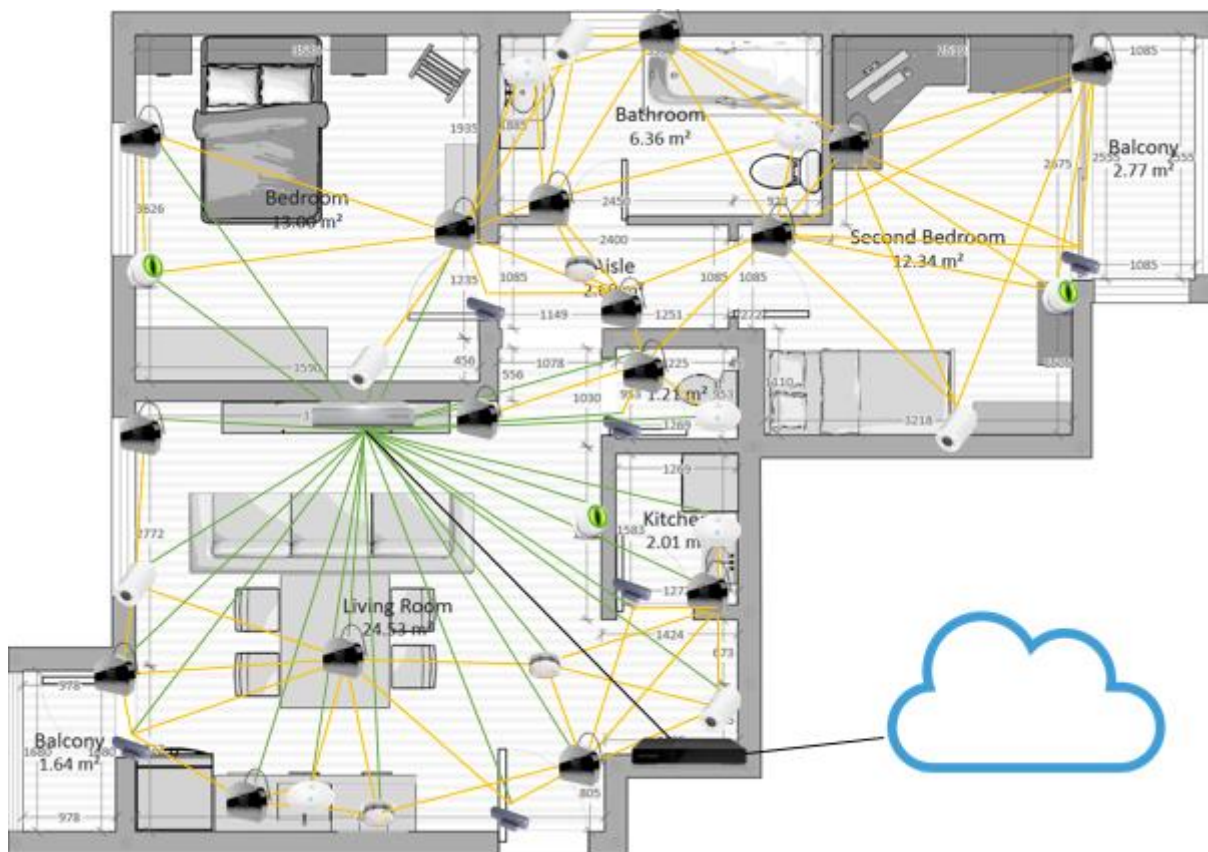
Výchozí půdorys pro byt 3+kk
